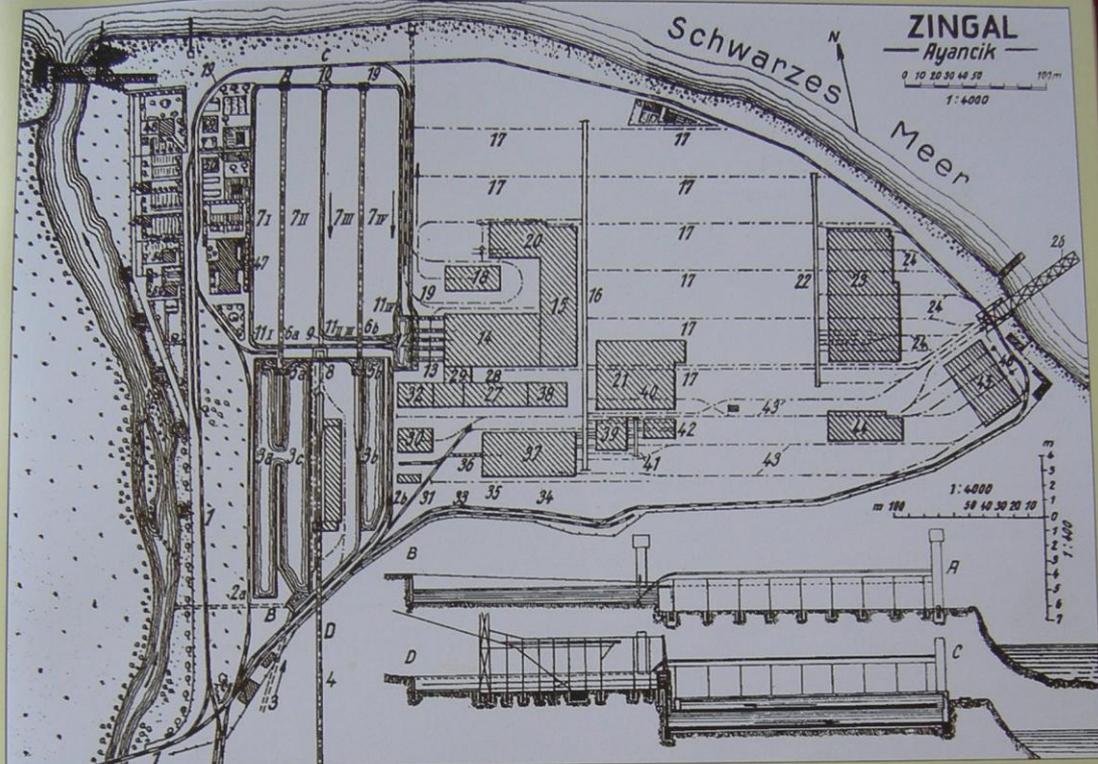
Lageplan des Sägewerks der ZINGAL AG in Ayancik.
